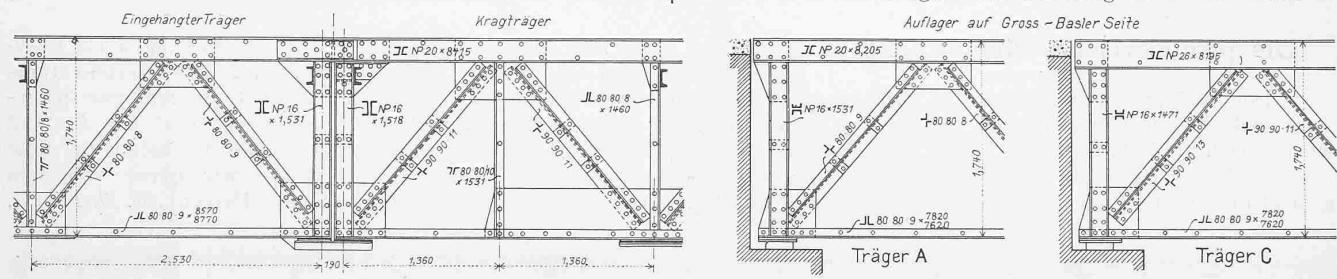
Details der Parallelträger. — Masstab 1:60.
